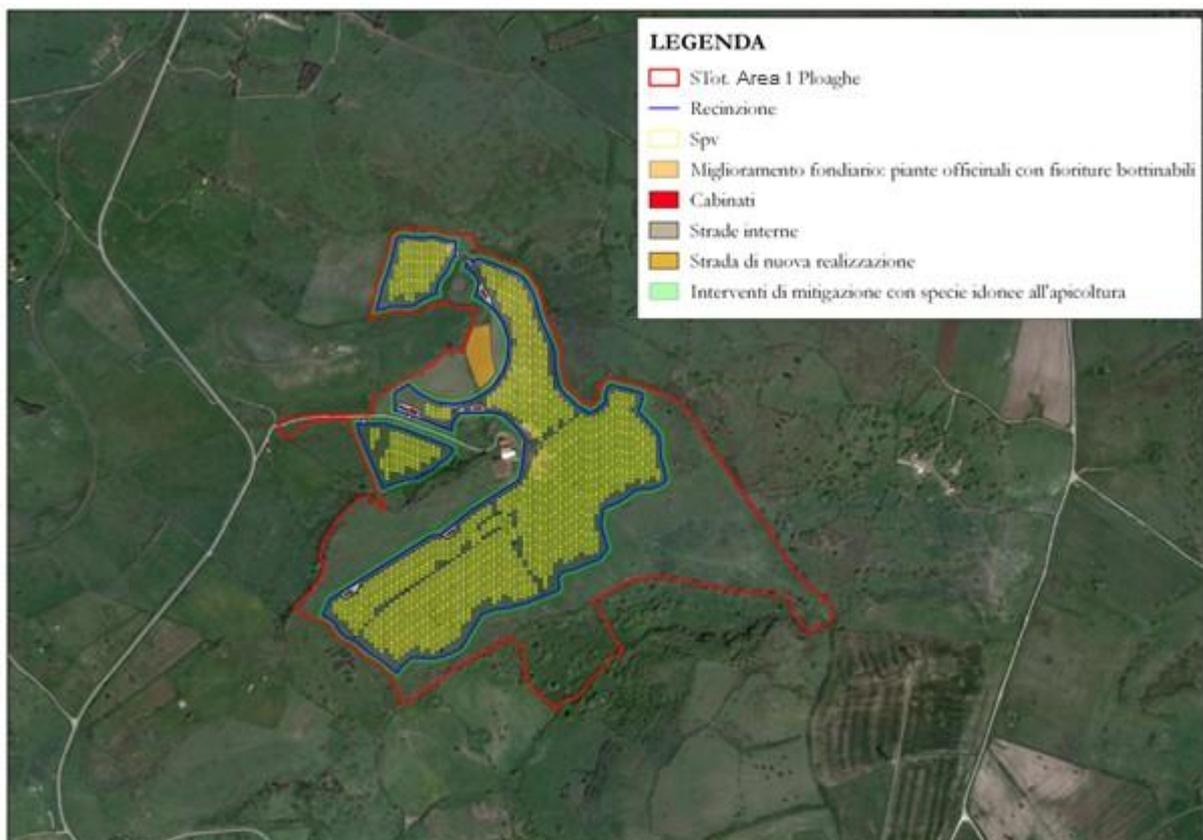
Layout di impianto Area 1 – Ploaghe (SS) con aree di nuova coltivazione di piante officinali quale miglioramento fondiario, da realizzarsi alle dovute distanze rispetto al perimetro della S_{pv} e delle recinzioni.
